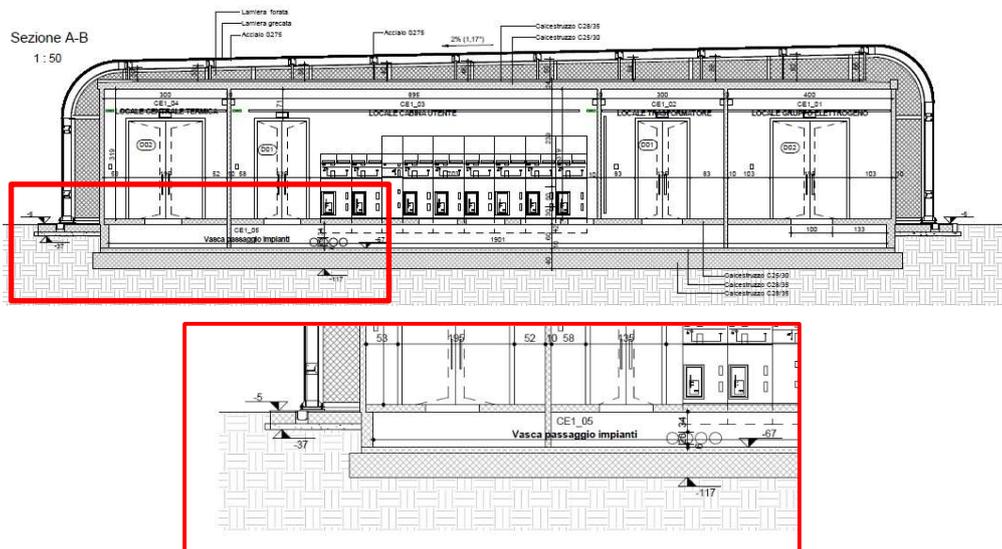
CE1 – sezione longitudinale e dettaglio fondamenta
